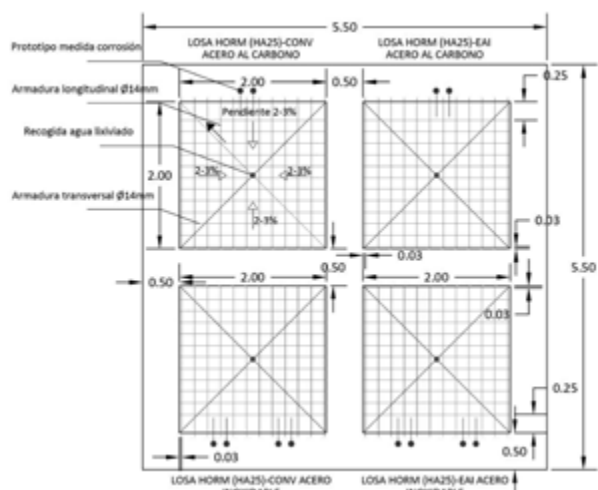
Losas armadas con acero al carbono y acero inoxidable ejecutadas con hormigón fabricado con EAI
